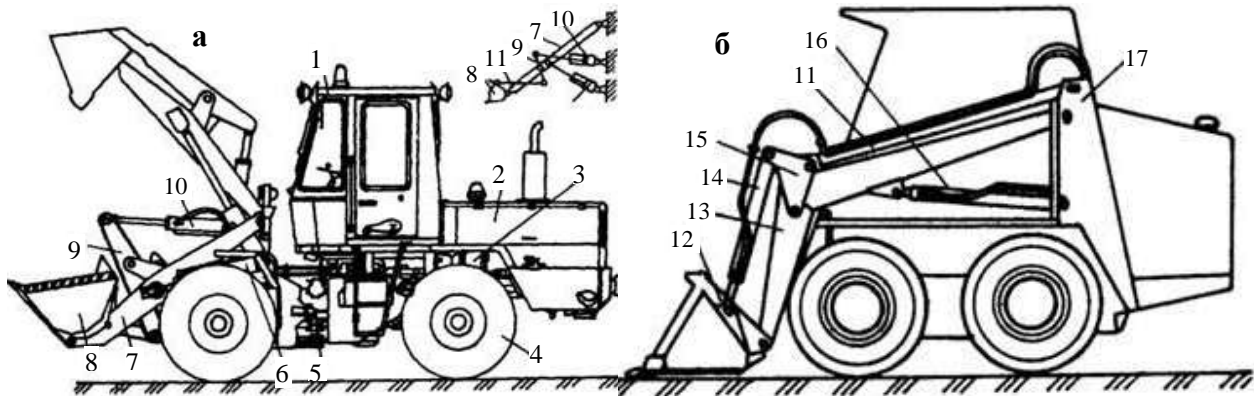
Схеми навантажувачів: а – фронтальний; б – малогабаритний універсальний;
